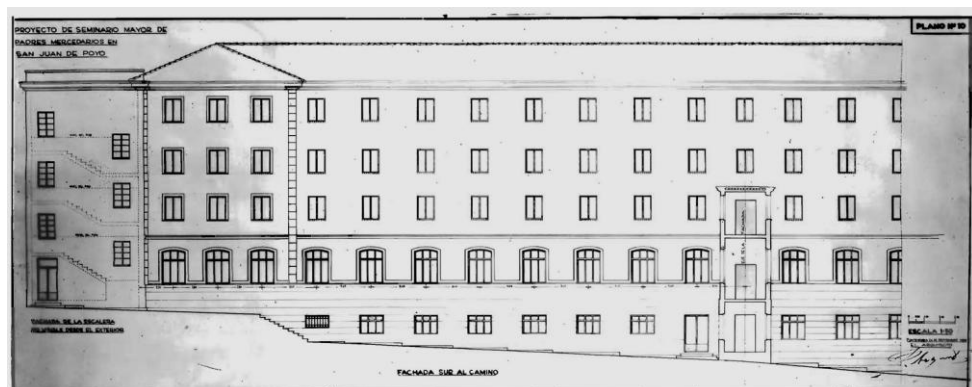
Fachada Sur. Fuente: Archivo Provincial.
